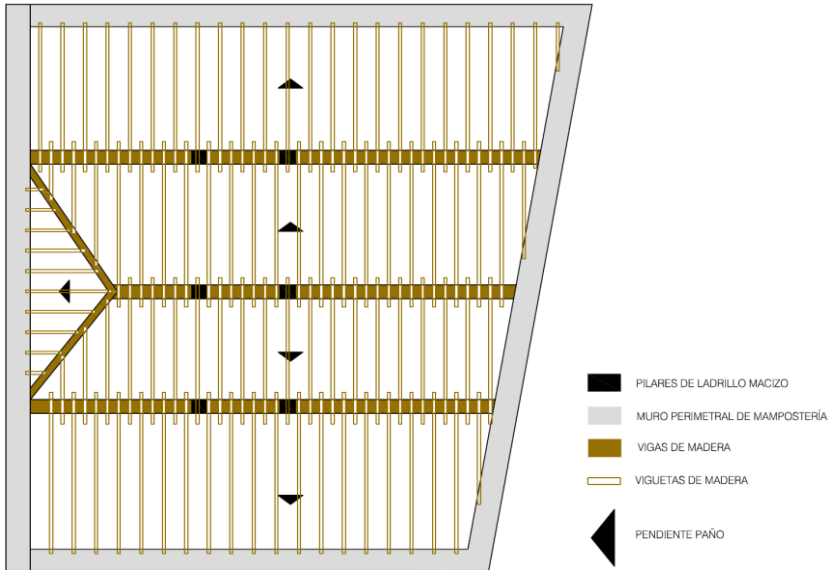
Esquema en planta de la estructura de la cubierta. 2023. Fuente: propia.
